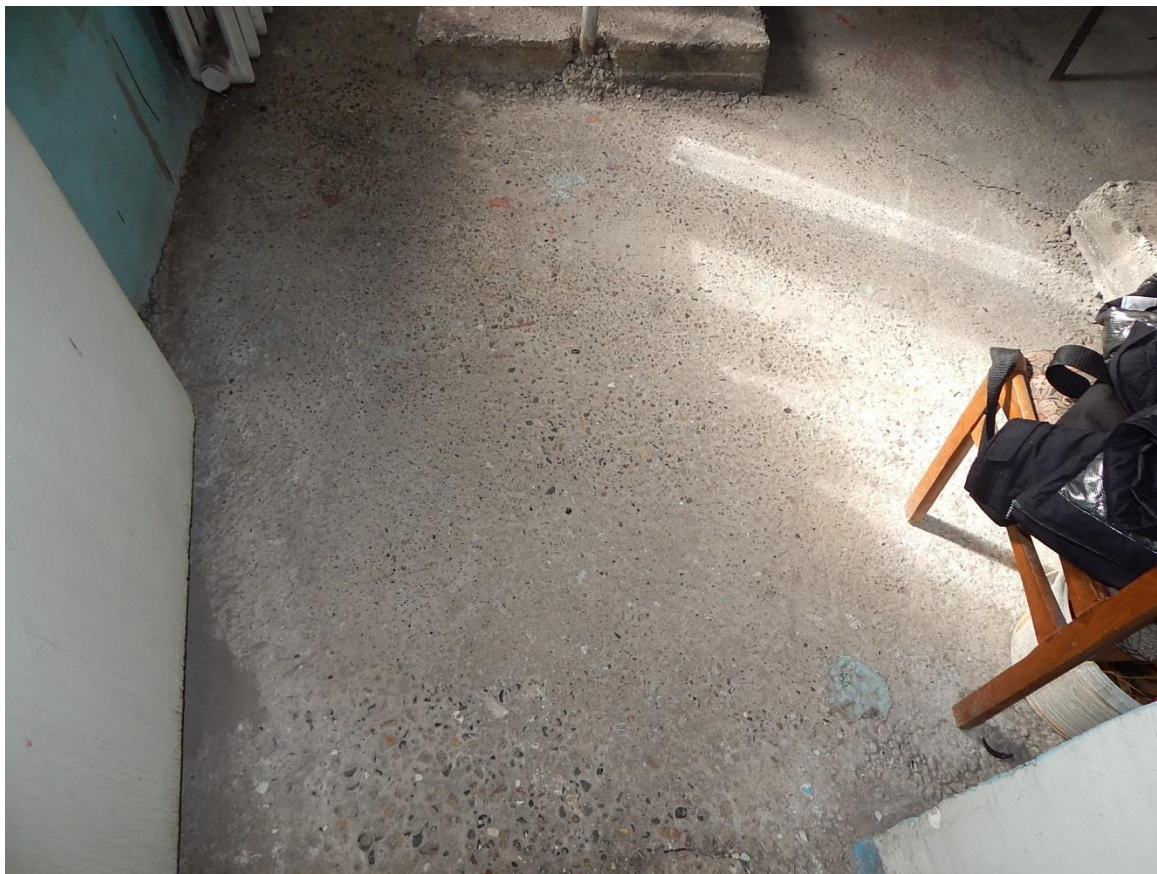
Внешний вид пола с бетонным покрытием в помещении вентиляционной
